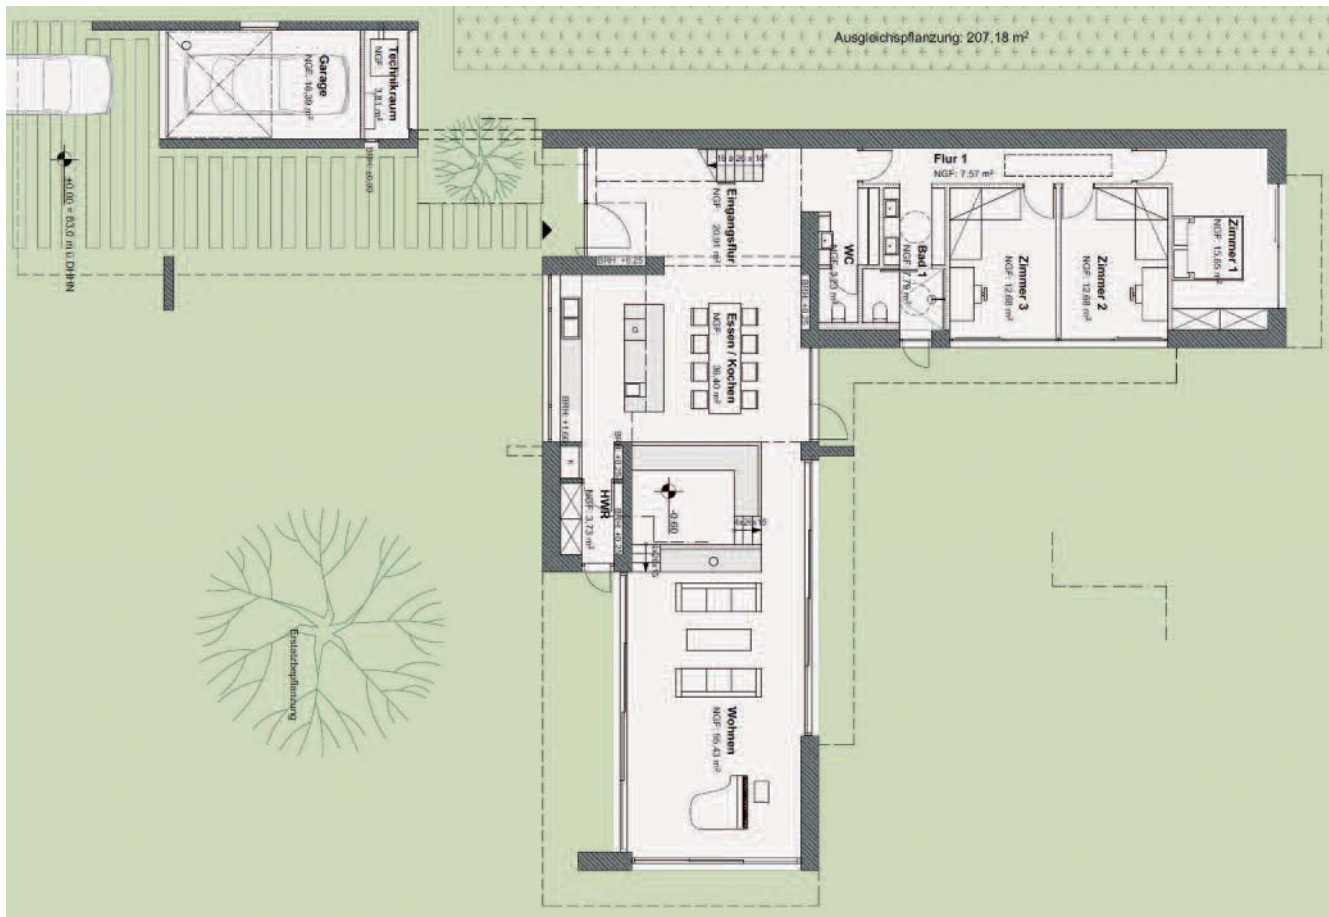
Grundriss des Landhauses aus Infraleichtbeton (Architekt: Prof. Clemens Bonnen (Berlin)) (siehe Abb. 10)
